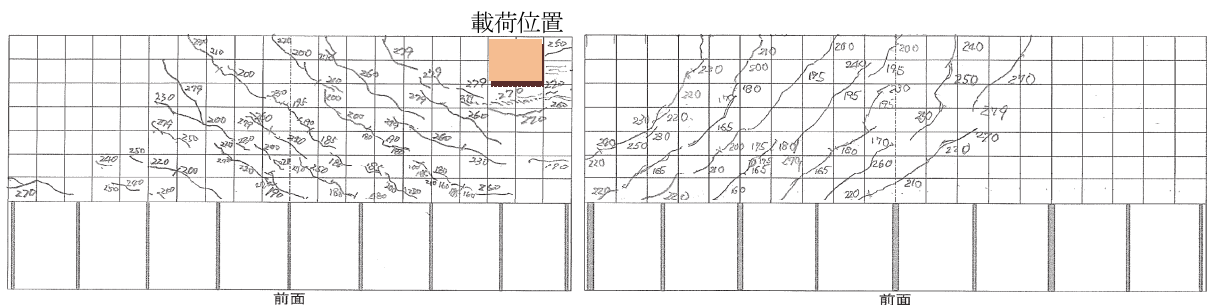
ひび割れ状況 (載荷試験終了時)
